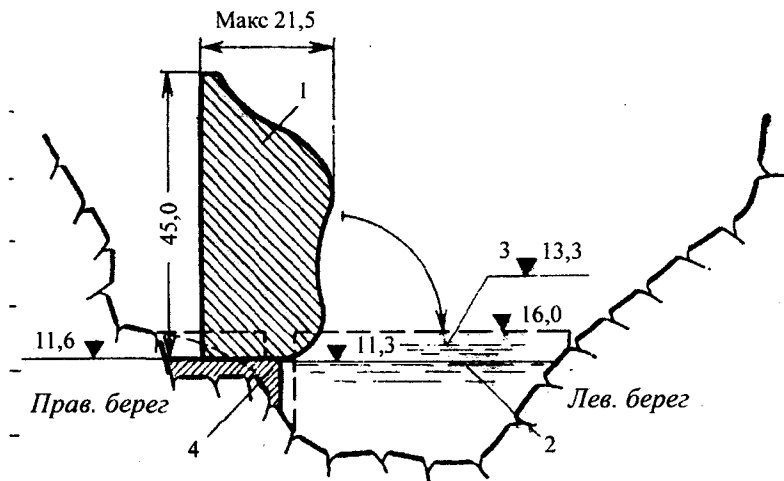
Перекрытие р. Куили Ниари на ГЭС Сунда бетонным массивом: 1 – бетонный массив, 2 – уровень воды, 3 – уровень воды после перекрытия, 4 – площадка для изготовления массива
